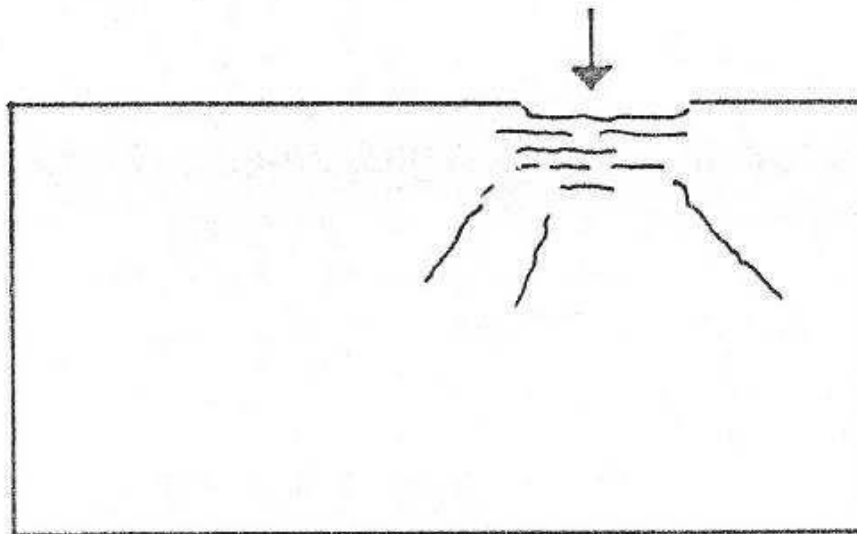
Fissuras verticais e horizontais causadas por sobrecarga vertical.
